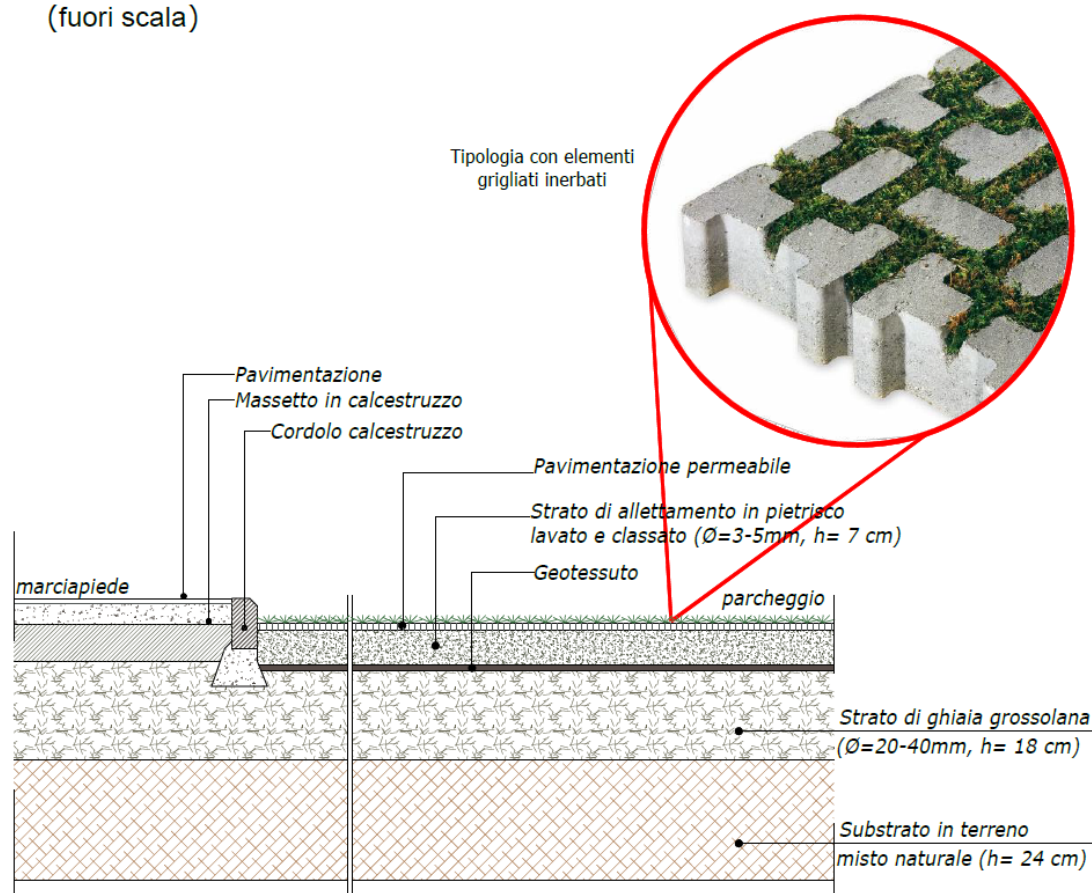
dettaglio costruttivo delle aree a parcheggio
